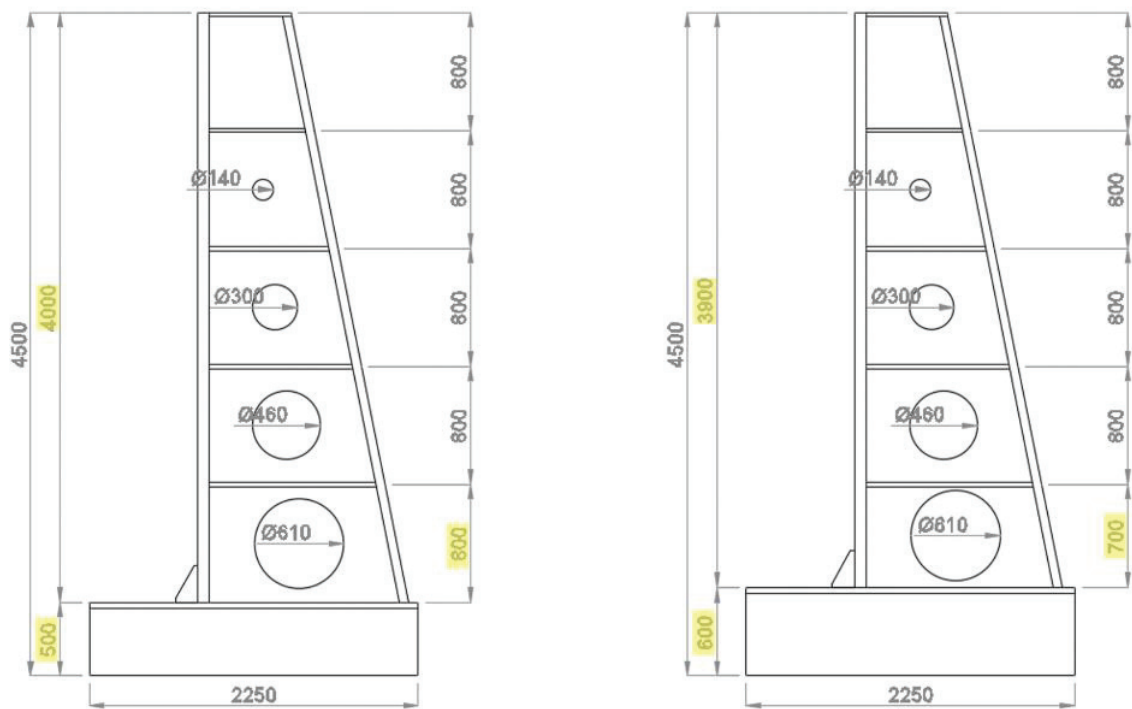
Prospetto lato di destra rispettivamente dei modelli strutturali N°3 e N°5
